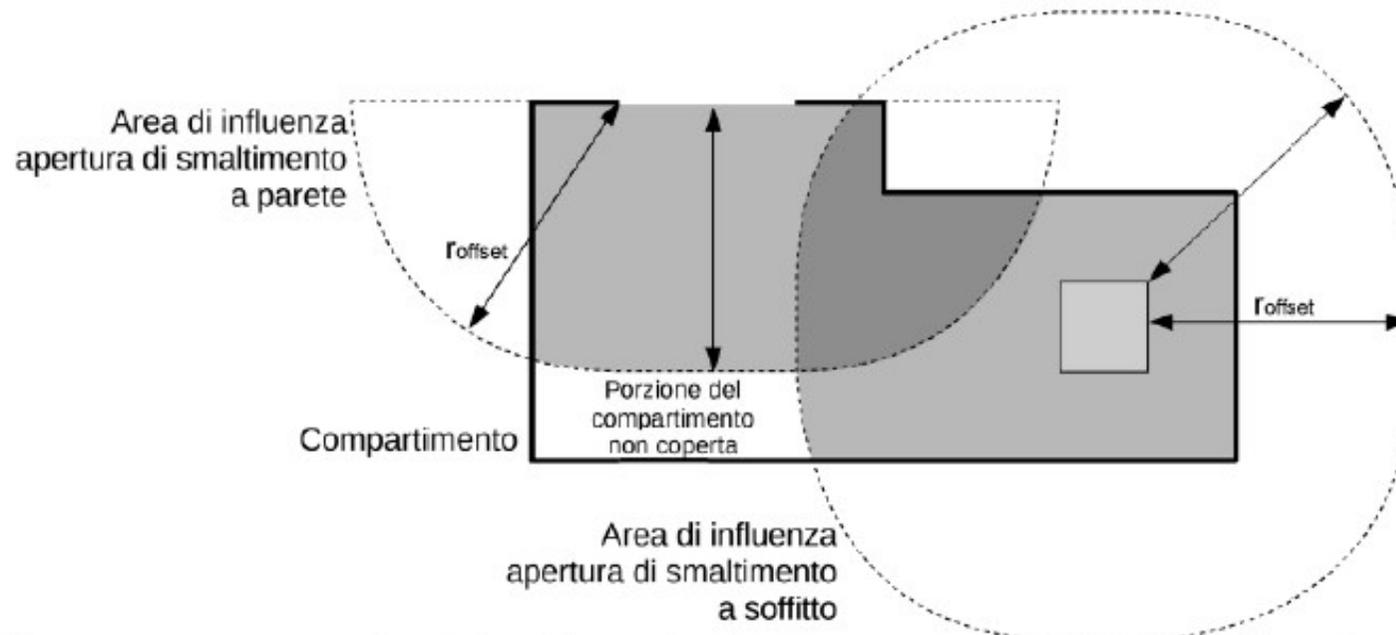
Verifica dell'uniforme distribuzione in pianta delle aperture di smaltimento
